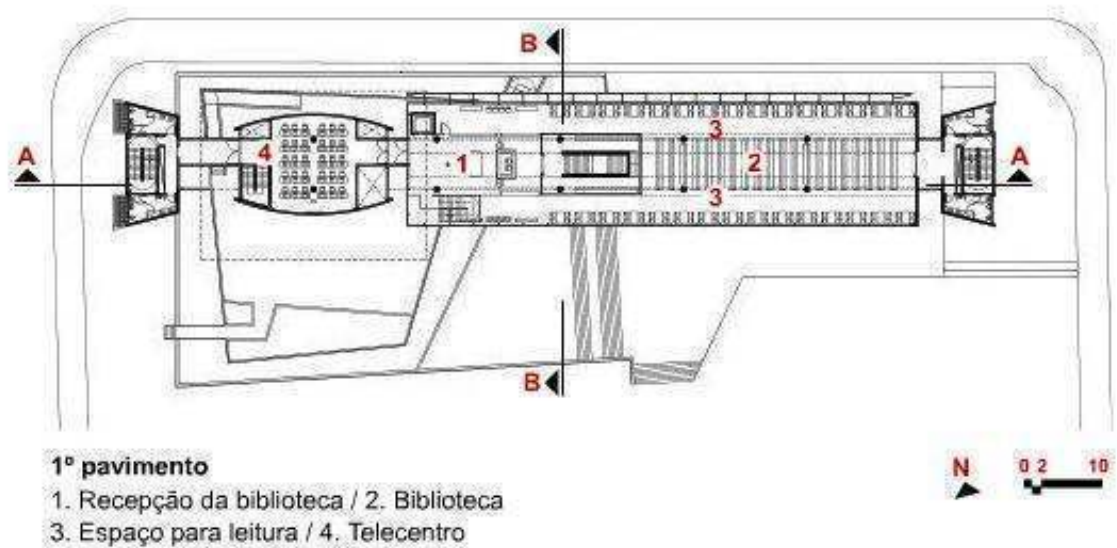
Planta baixa 1º pavimento (ARCOWEB, 2010a)
